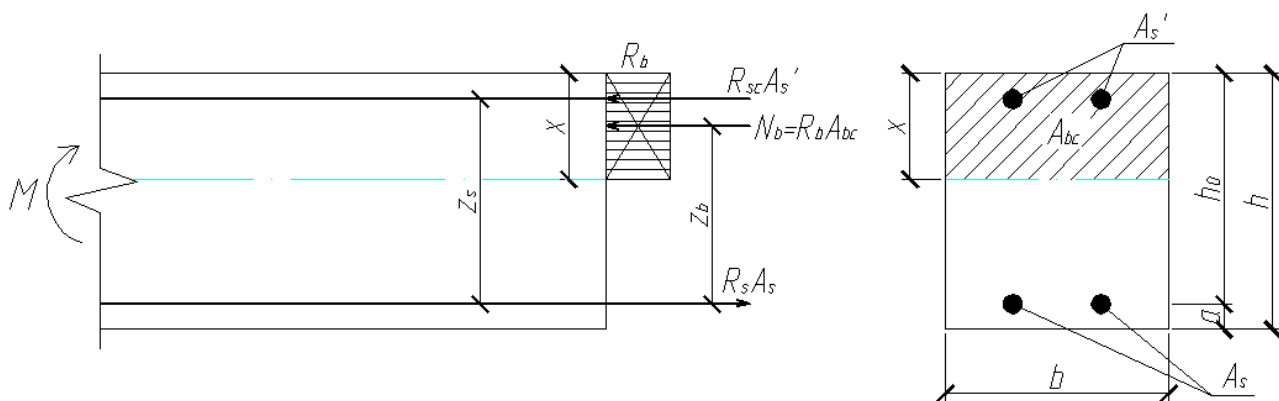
Схема внутренних усилий главной балки в пролете
